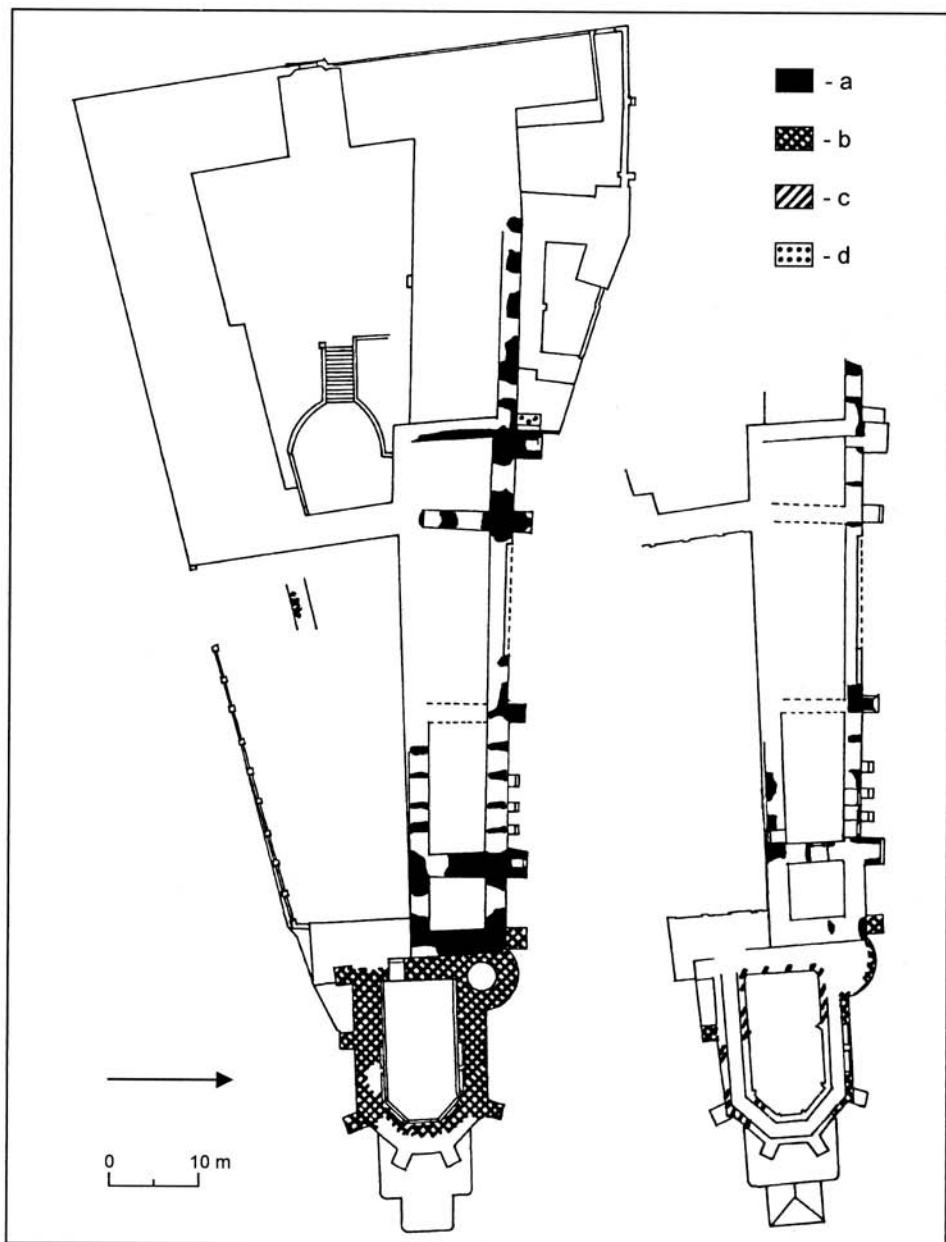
Nižbor. Grundriss der Burg (in den Umriss des heutigen Schlosses eingezeichnet). Links Erdgeschoss, rechts I. Obergeschoss. Legende: a - Mauerwerk der ersten Bauphase; b - Mauerwerk der zweiten Bauphase; c - wahrscheinlich Mauerwerk der zweiten Bauphase; d - jüngerer mittelalterliches Mauerwerk. Kenntnisstand 2001. Zeichnung: V. Durdík.
